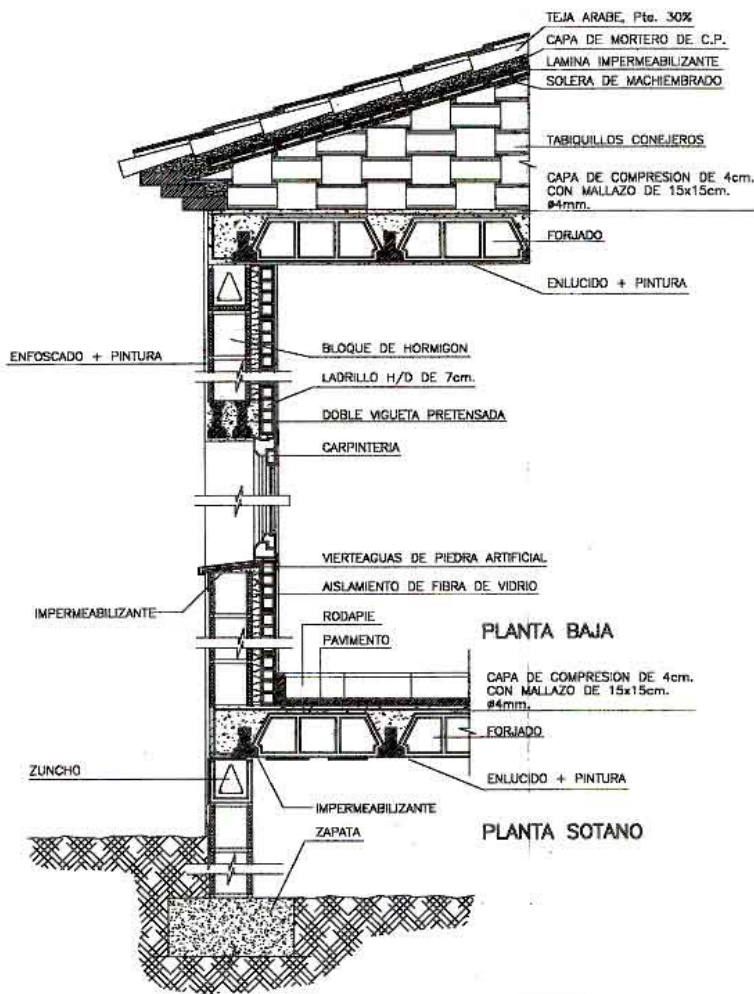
Sección constructiva de la vivienda Fuente;www Arquitecturba.com
